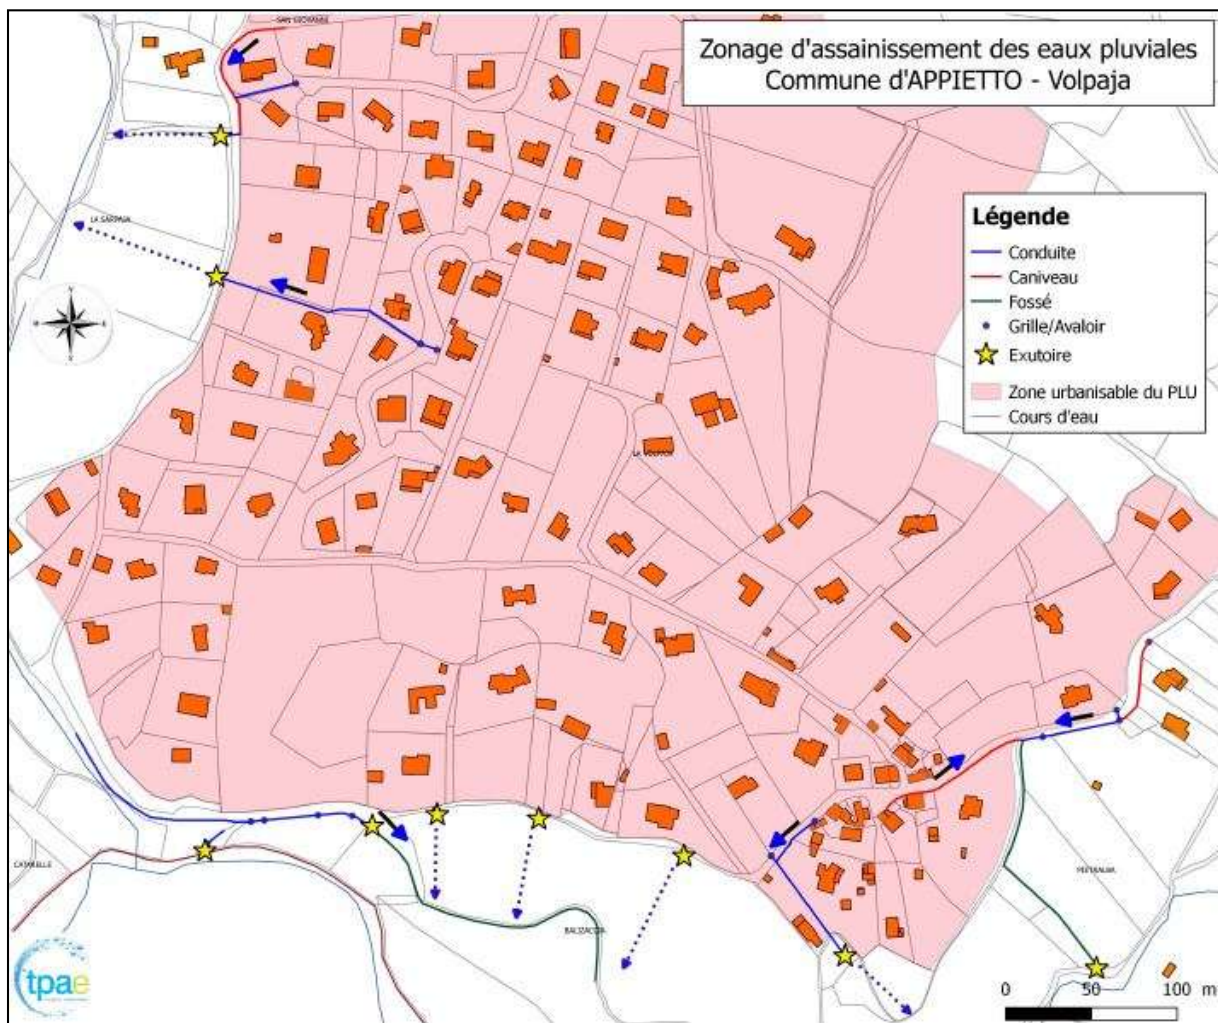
Plan du réseau pluvial du hameau Volpaja
